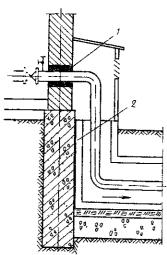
3 Вводы трубопроводов в здание с проветриваемым подпольем при прокладке труб
